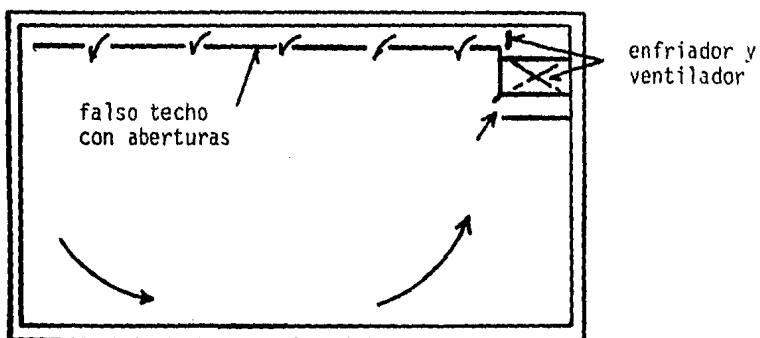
Cámara con falso techo y aberturas para la distribución uniforme del aire. (26).
